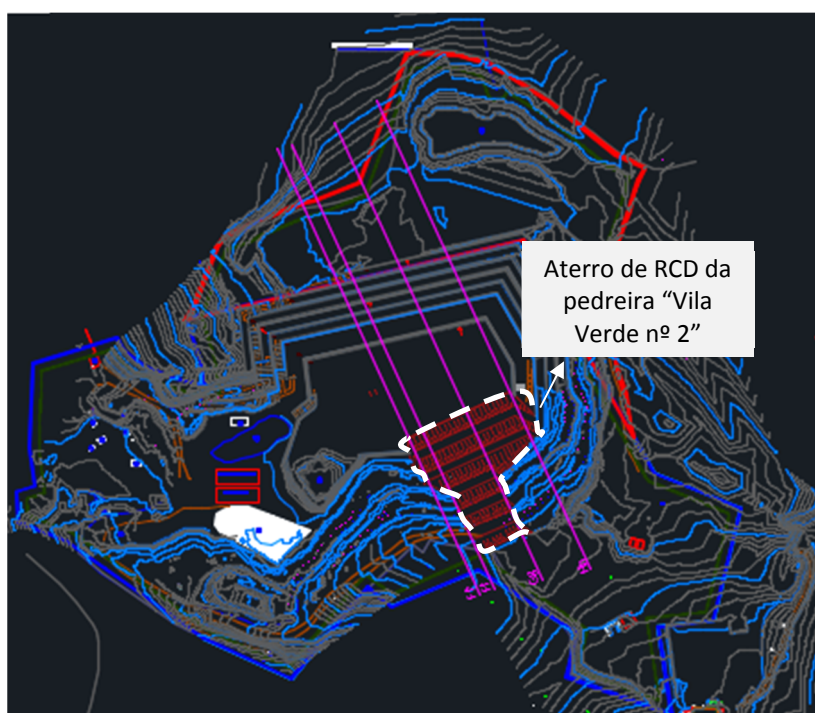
Planta de localização do aterro final de RCD da pedreira "Vila Verde nº 2"
